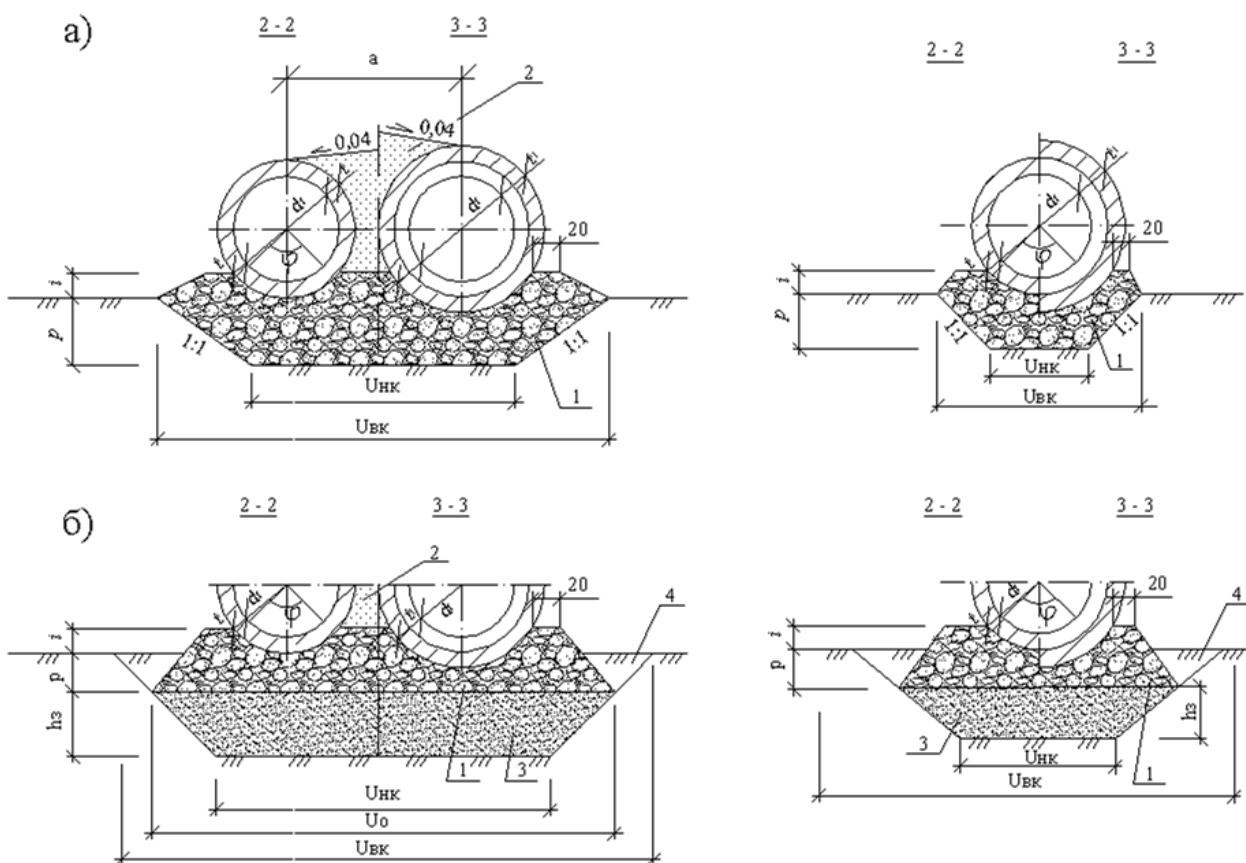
Поперечные разрезы труб на подушке из ПГС (щебня): без замены грунта основания (а) и с заменой (б): 1- ПГС (щебень); 2- засыпка пазух ПГС; 3- замена грунта основания; 4- обратная засыпка котлована.
